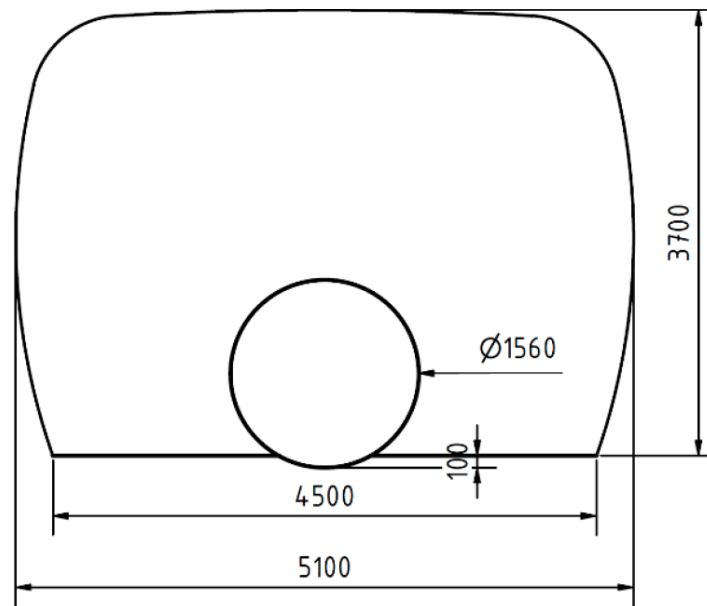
Querschnittsprofil der Einlagerungsstrecke für die Streckenlagerung wärmeentwickelnder Abfälle /BGE 22/
